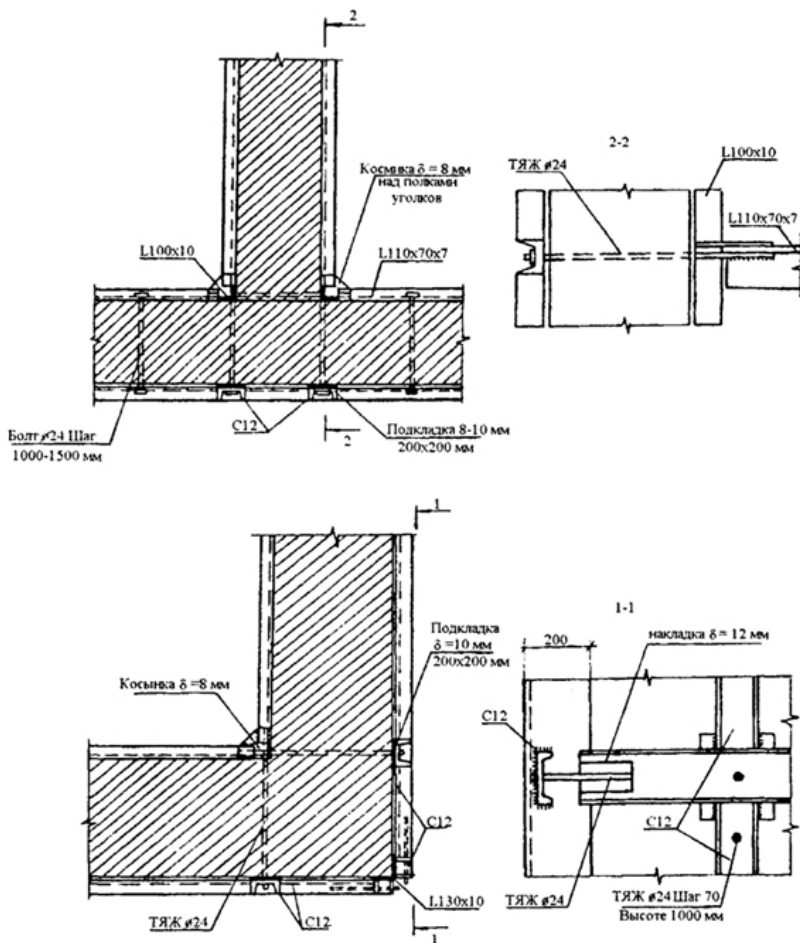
Детали крепления здания по типу наружного каркаса
